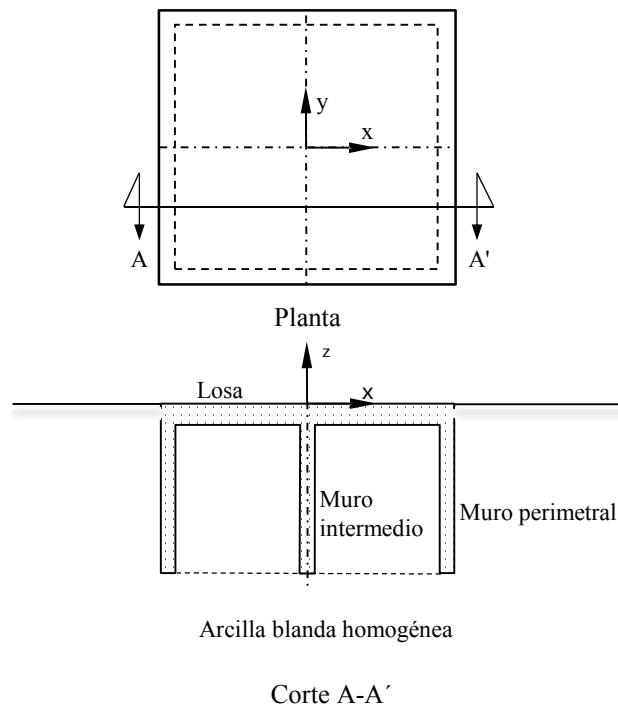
Esquema de una celda estructurada de cimentación de concreto armado
